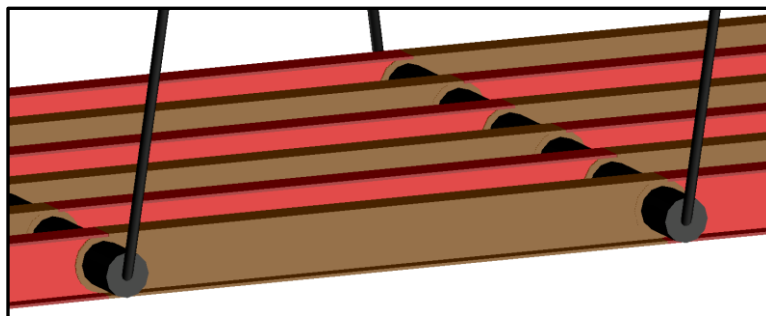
Ligação de apoio entre longarinas e carlinga”
